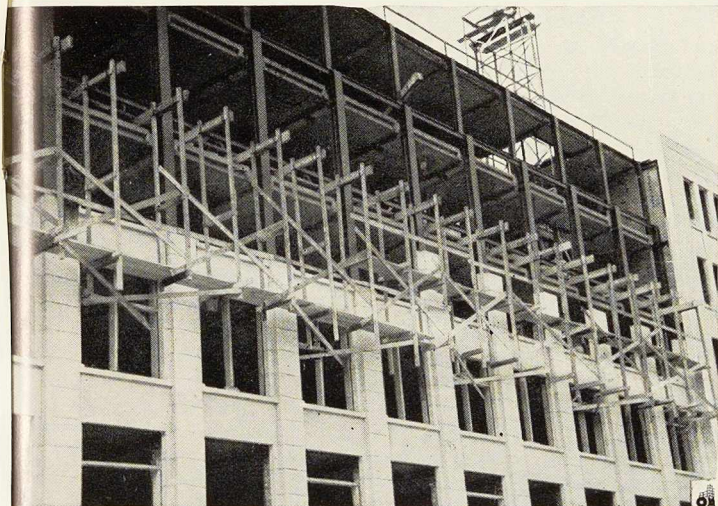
Bâtiment du Budget, rue Ducale à Bruxelles. Vue prise en cours de construction.
